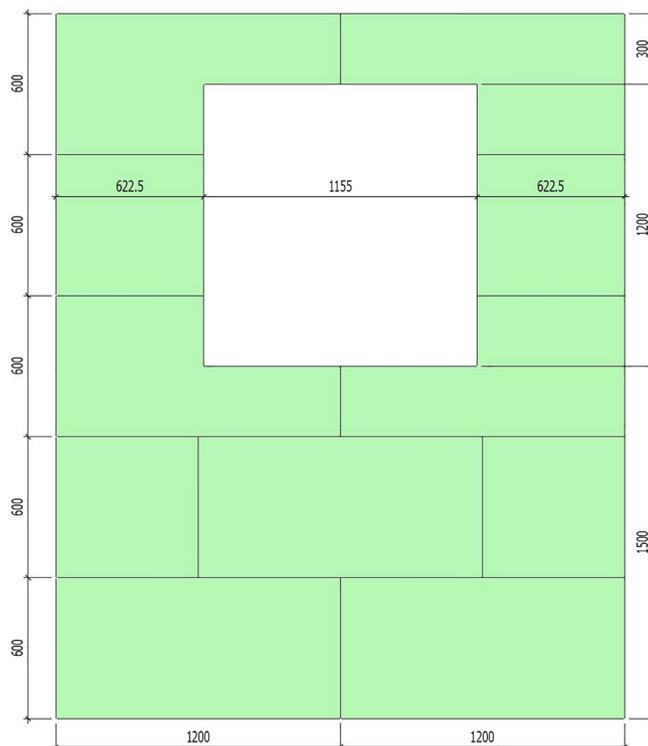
Calepinage des panneaux isolant support d'enduit sur la maquette
